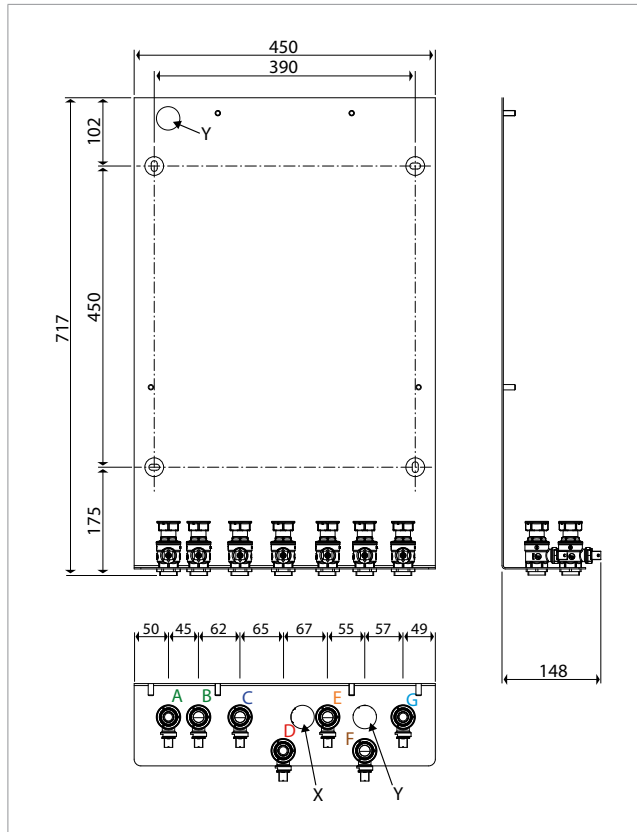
dimensioni in mm (dima GE551Y082) / dimensions in mm (GE551Y082 template)
